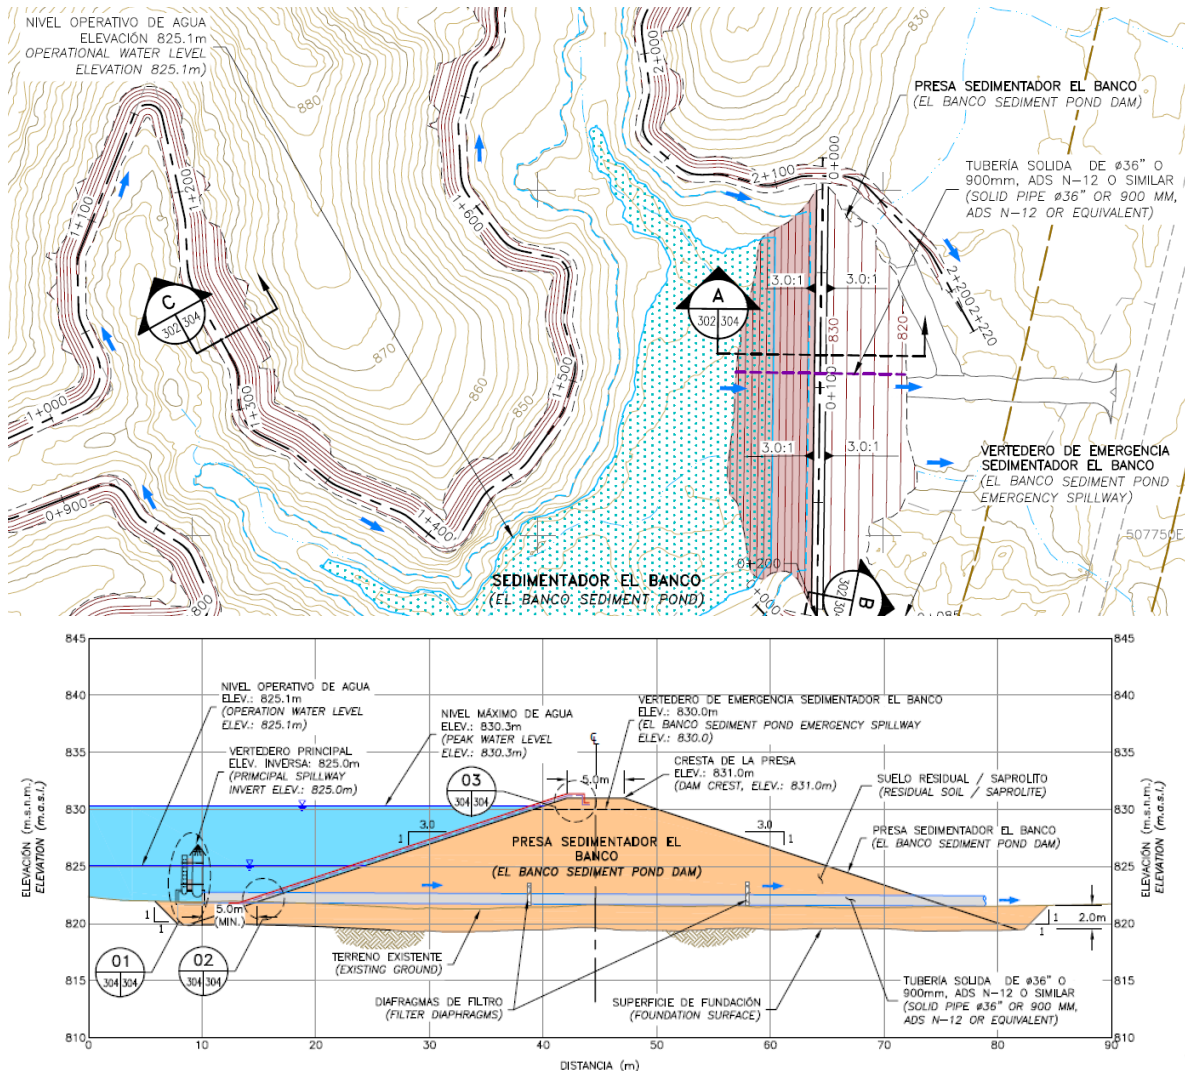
Planta, perfil del sedimentador El Banco
